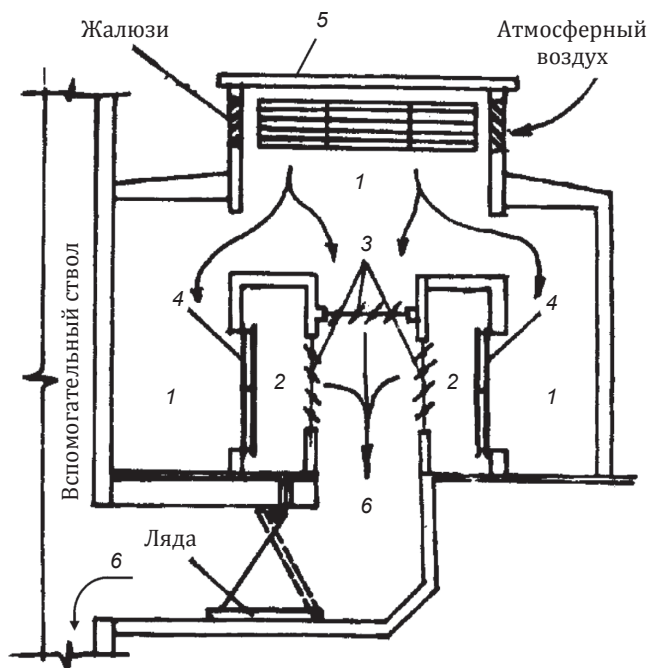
Схема типовой калориферной установки: 1 – потоки холодного воздуха; 2 – потоки нагретого воздуха; 3 – многостворчатая регулируемая решетка; 4 – воздухонагреватели КСК4-12; 5 – воздухозаборная будка; 6 – калориферный канал.
